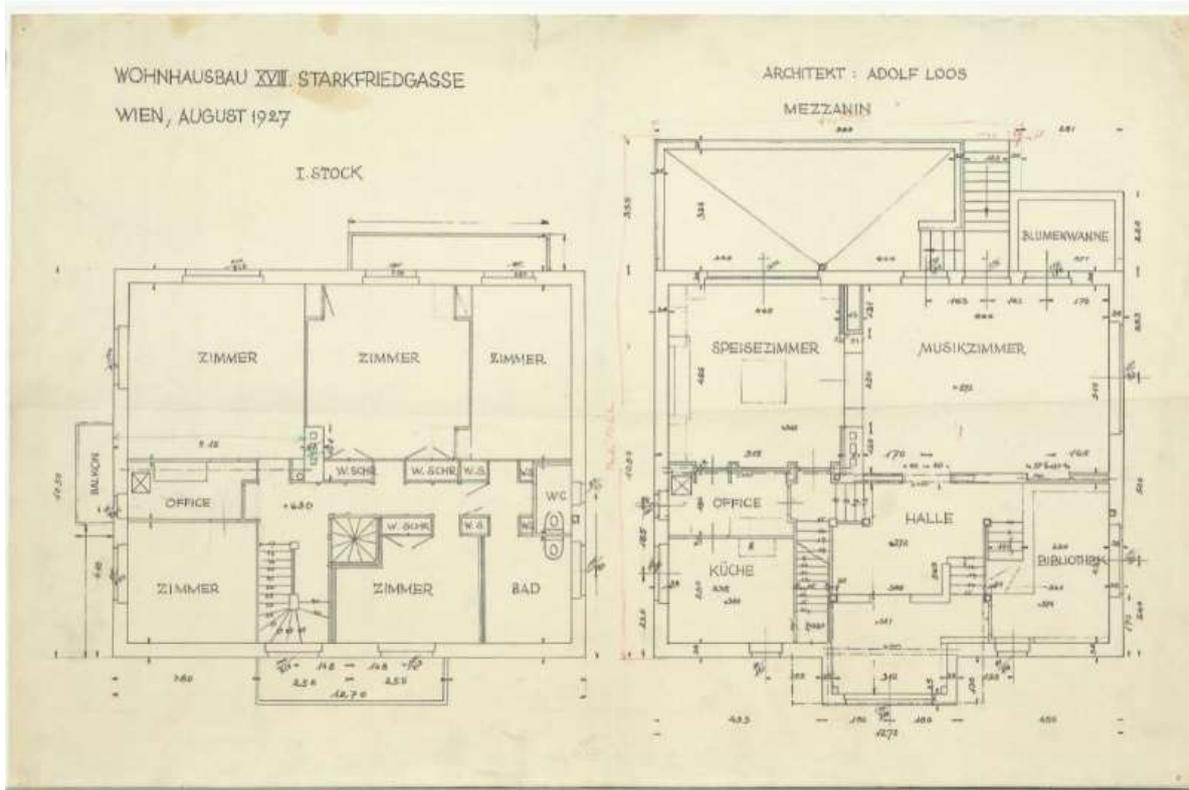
Plan du *piano nobile* (Mezzanin) et Plan du niveau chambres (Zimmer) 1927
